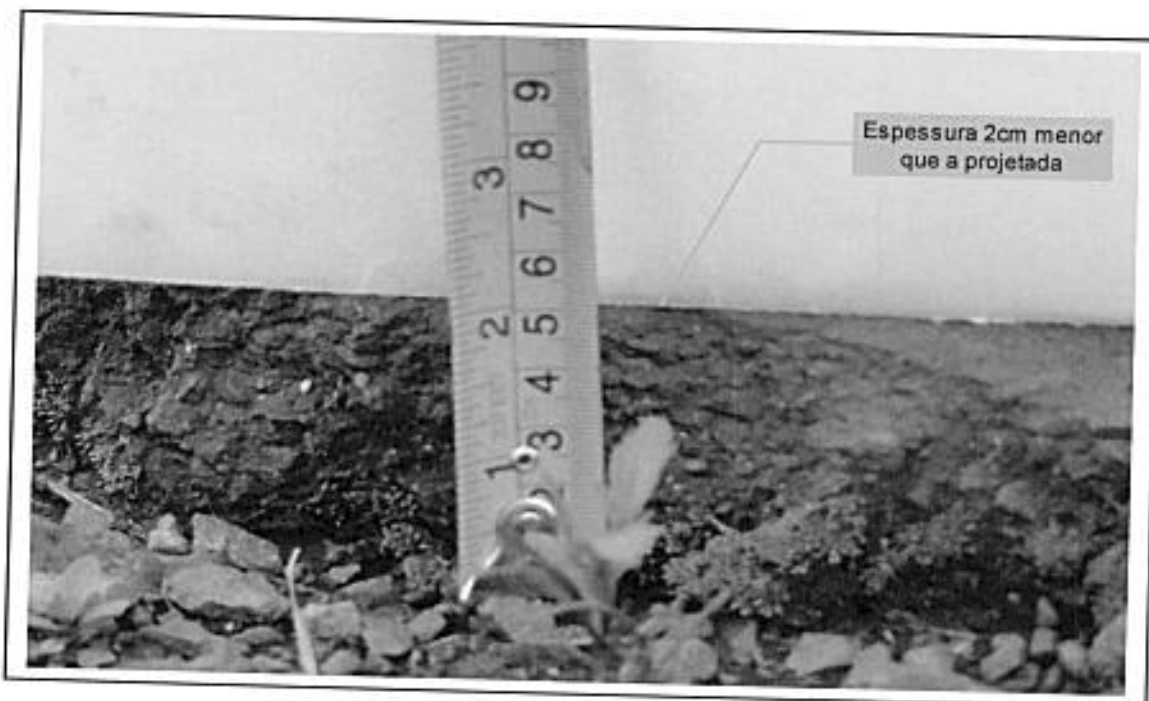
Reperfilagem+Capa Asfáltica - espessura de 5 cm.
